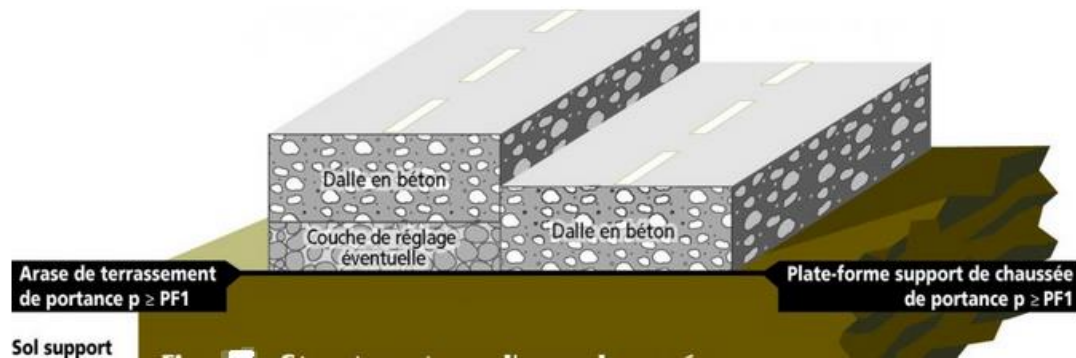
structure type d'une chaussée rigide à trafic ≤ 50 PL/j/sens.
